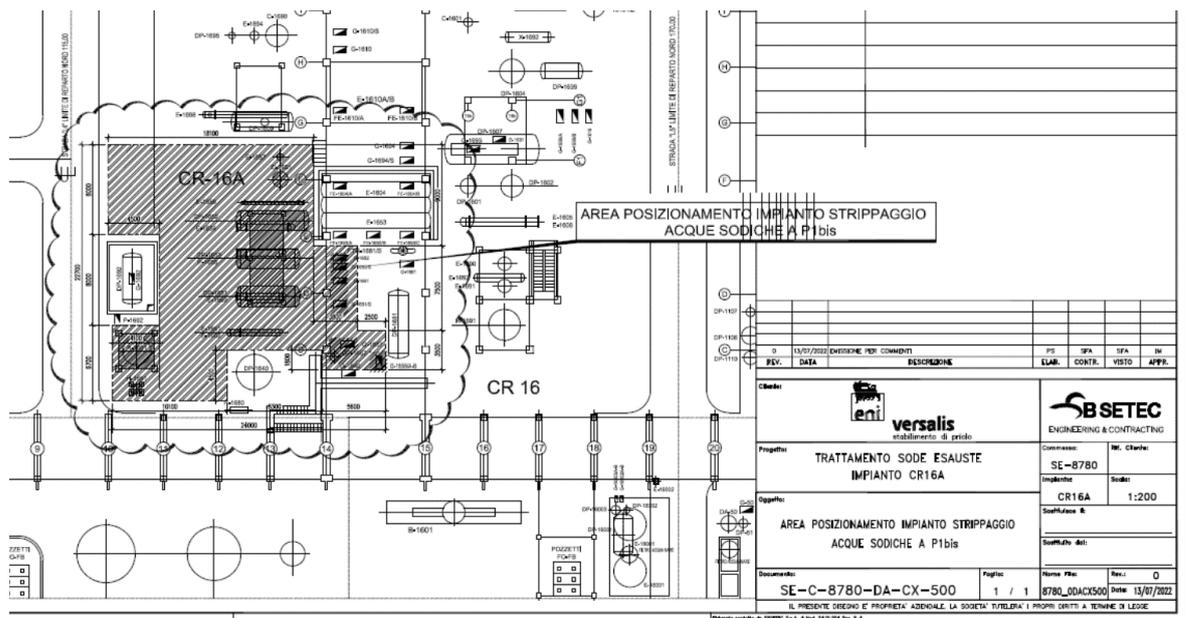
Posizionamento planimetrico nuovo impianto strippaggio sode Area CR16A Impianti Aromatici
